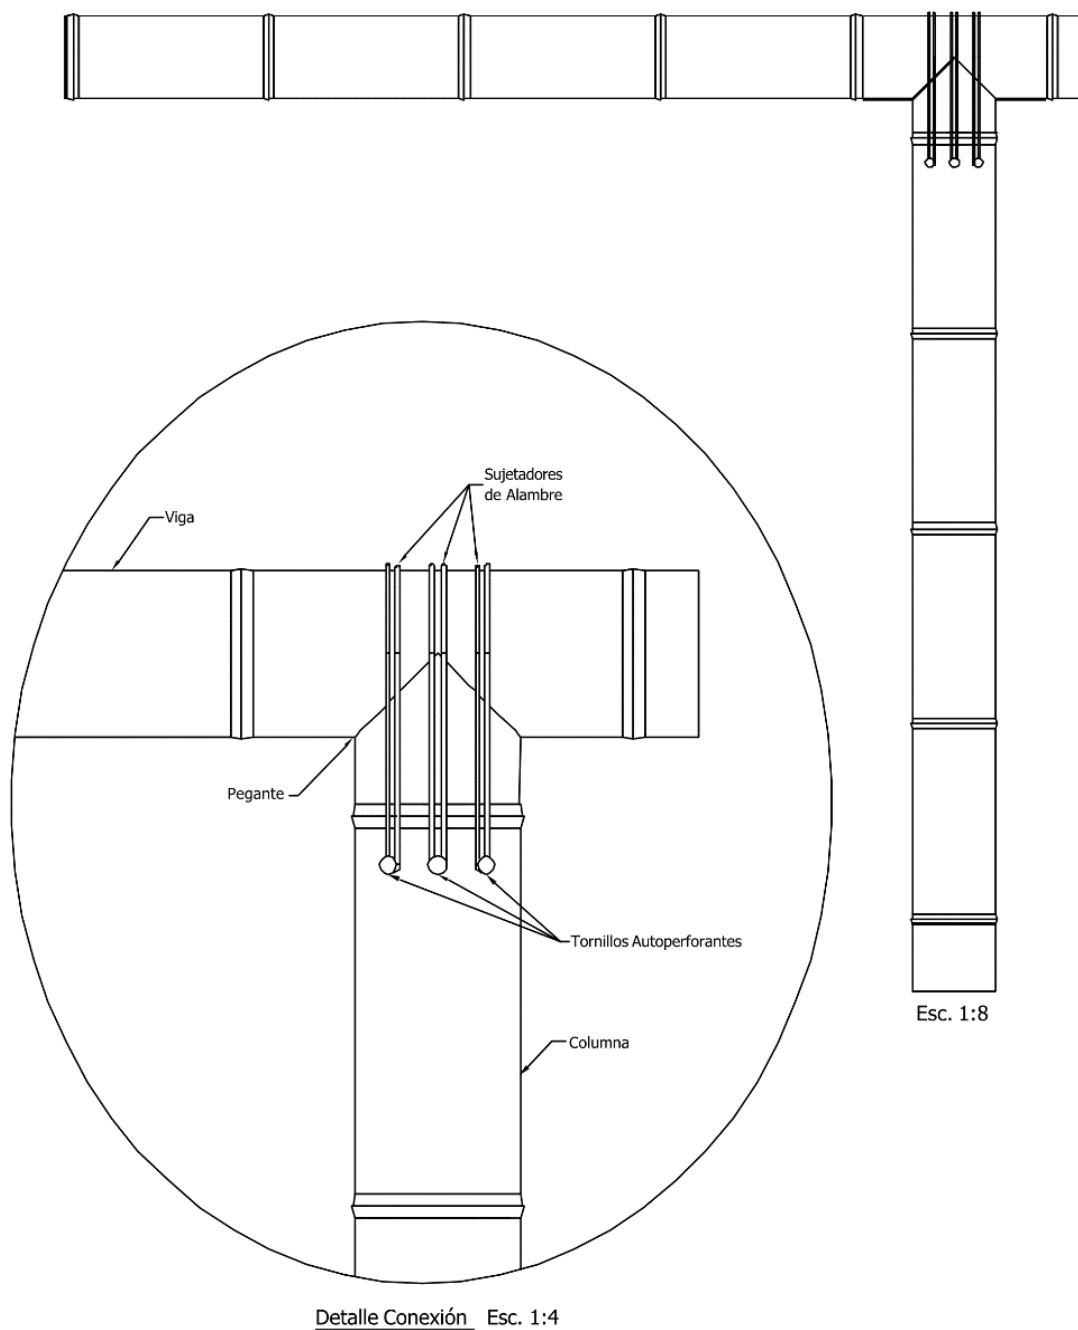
Plano de conexión en boca de pescado y amarre de alambre.
